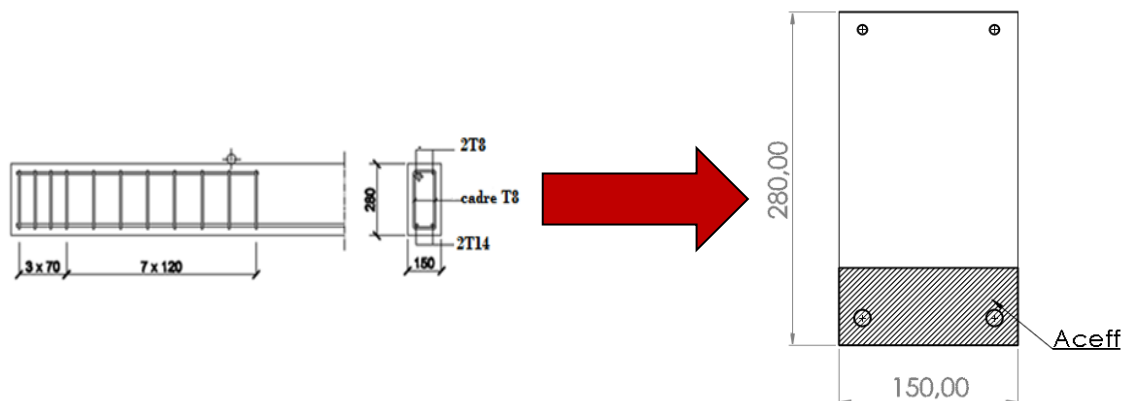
Définition de la zone efficace considérée pour la poutre étudiée.
